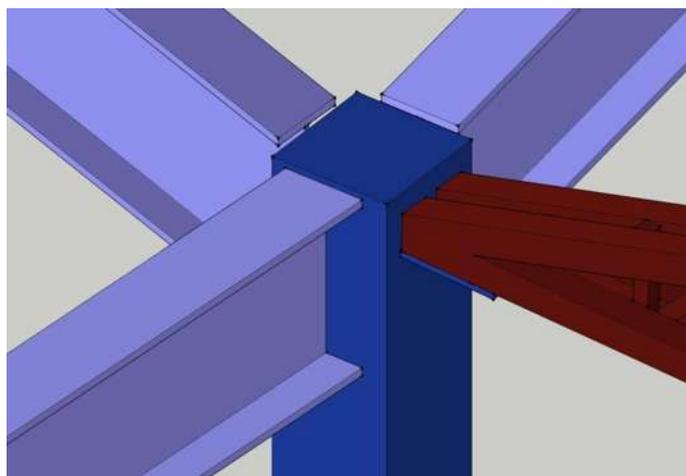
Perspectiva de estructura metálica, se muestra al centro la columna tipo HSS, a su alrededor vigas de tipo IPR y armadura apoyada sobre placa.
